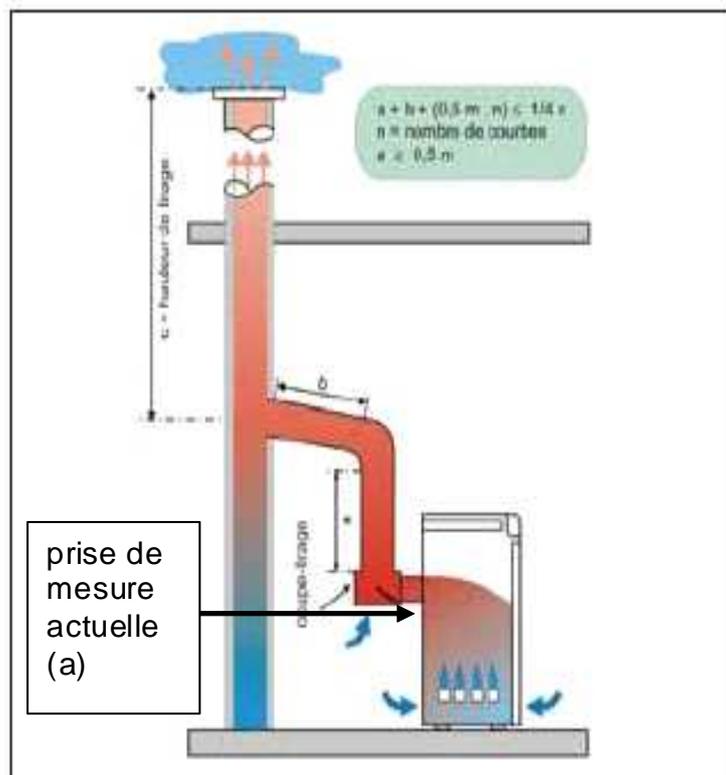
Générateur de chaleur équipé d'un dispositif anti-refouleur / coupe tirage
